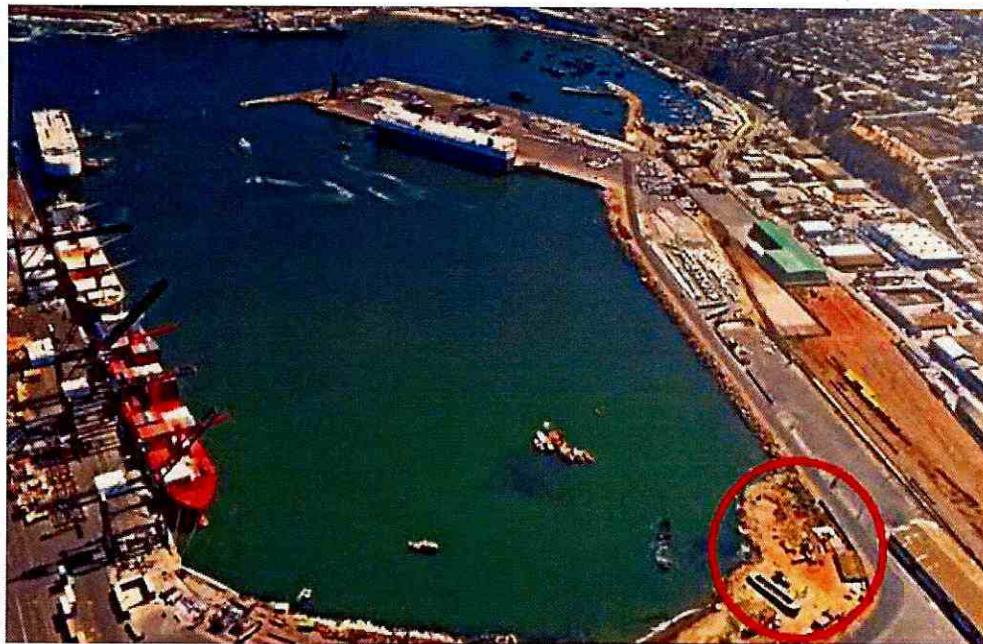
situación sin proyecto. En el extremo inferior de la imagen, en el sector donde se dibujó un círculo de color rojo, se puede apreciar parte del sector de playa y pavimentos, la cual se conoce en su conjunto como el fondo de la poza del puerto de San Antonio. Con motivo de la ejecución del proyecto Muelle Costanera San Antonio, sobre dicha área se realizaron excavaciones superficiales para efectos de construir las nuevas explanadas a que hace referencia la RCA N°51/2013.
